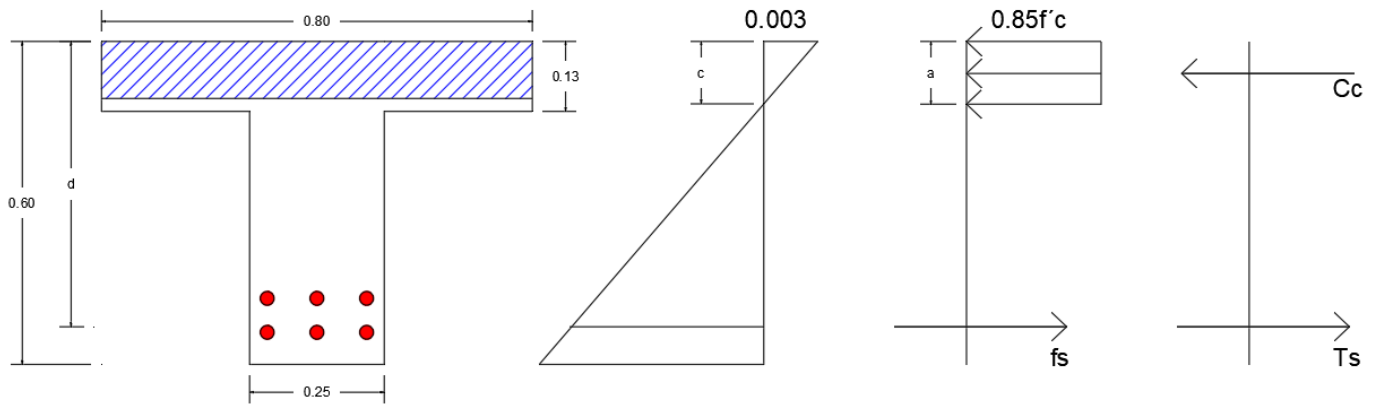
Detalle esfuerzos y deformaciones, viga T.
